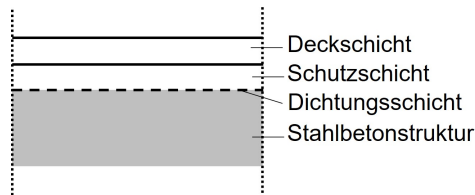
Exemplarischer Querschnitt des Fahrbahnaufbaus einer Stahlbetonbrücke
